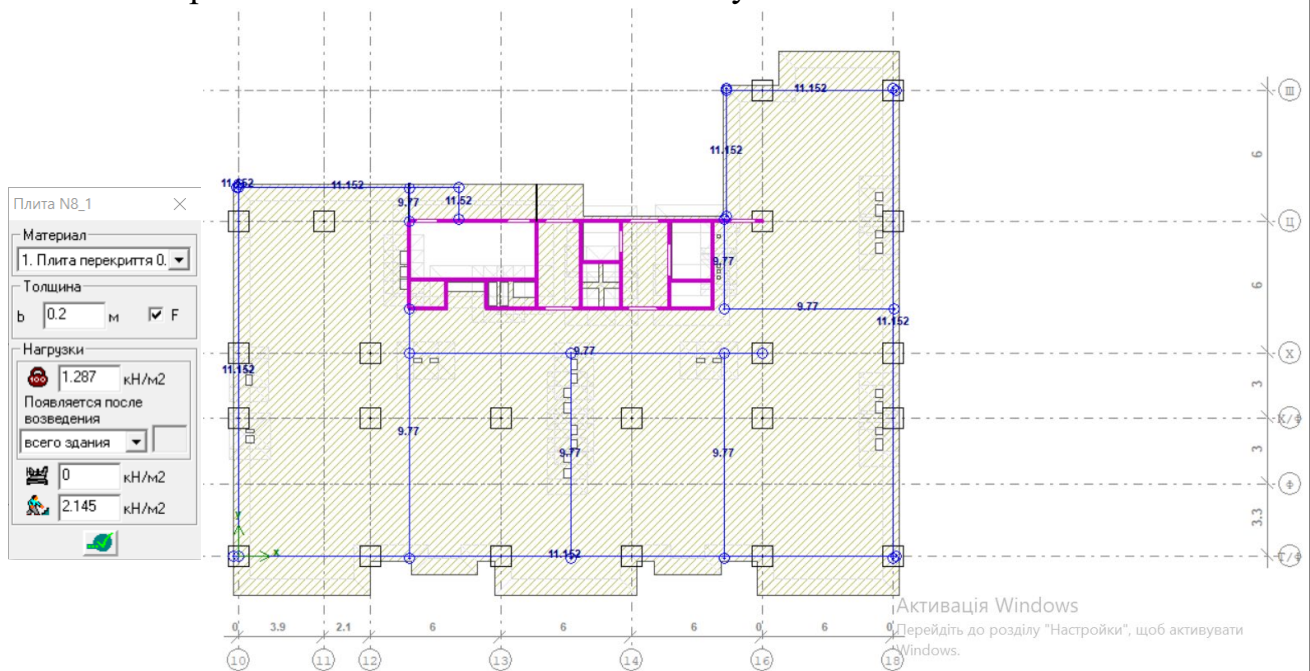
План плити перекриття типового поверху , на відм + 15.700
